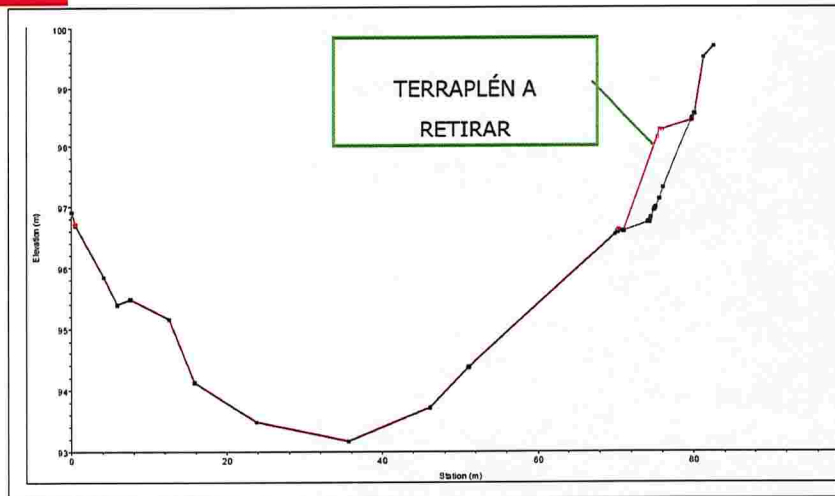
Perfil Km 0+800 sin proyecto (SP) en color magenta y con proyecto (CP) en color negro.
